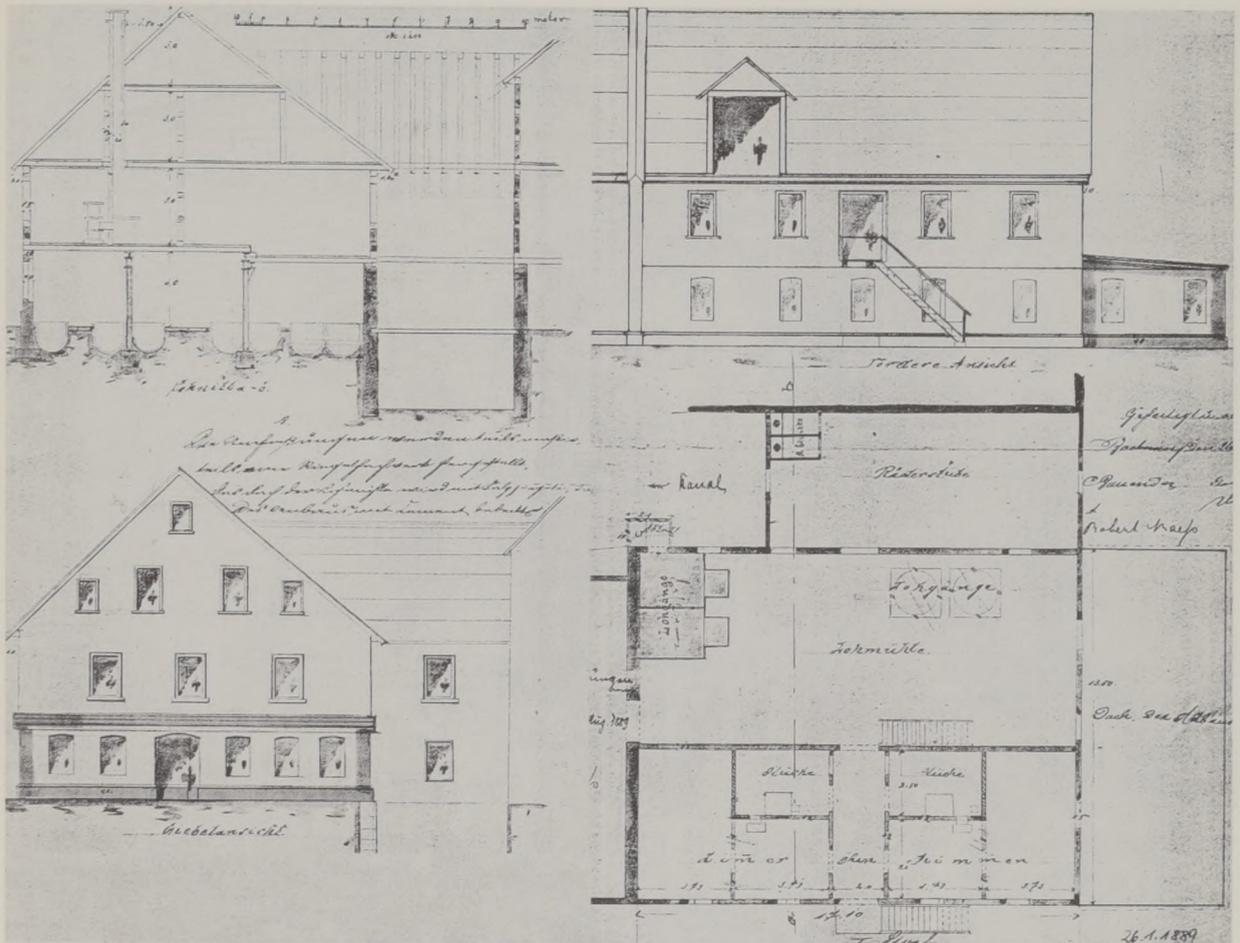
Grundriss, Schnitt und Ansichten der 1888/89 erheblich vergrößerten Lohmühle 538 (Fabrikstraße 45 G) mit der an der Giebelseite angebauten Äscherwerkstatt. Nach Verlegung der Lohmühle in den 1. Stock war das EG zur Farbenwerkstatt ausgebaut worden.
